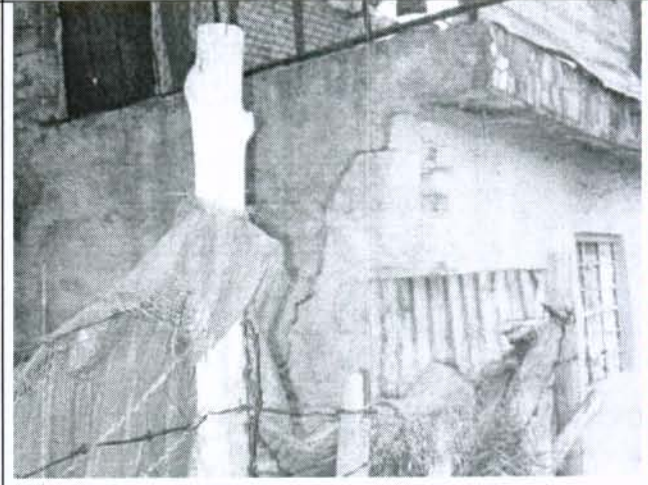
La vivienda de la carrera 7 este # 0 - 20 presenta agrietamientos en muros, pisos y fachada.
